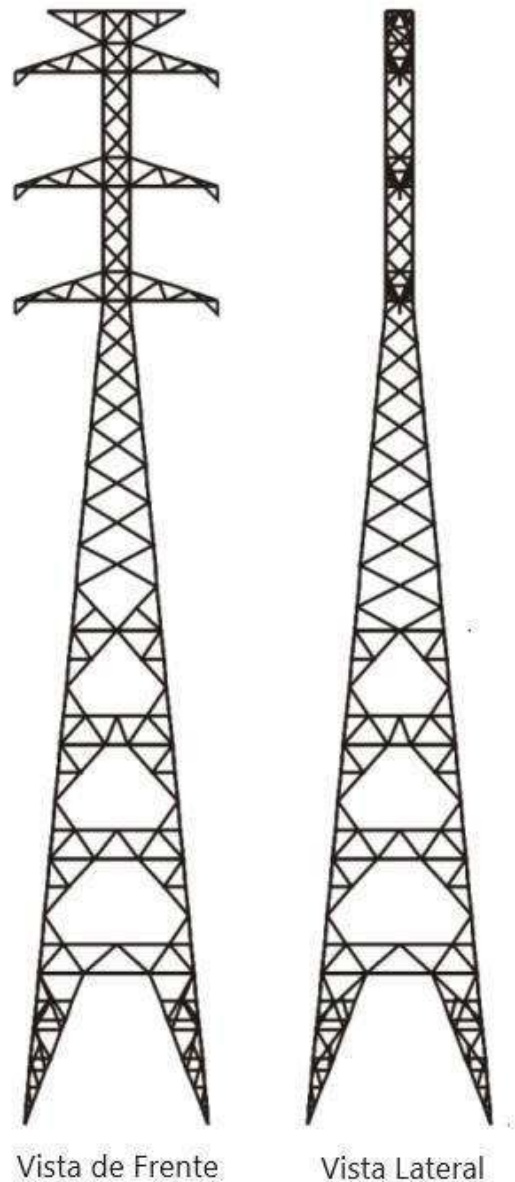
Esquema Estructura Metálica LAT 2x132 kV.
